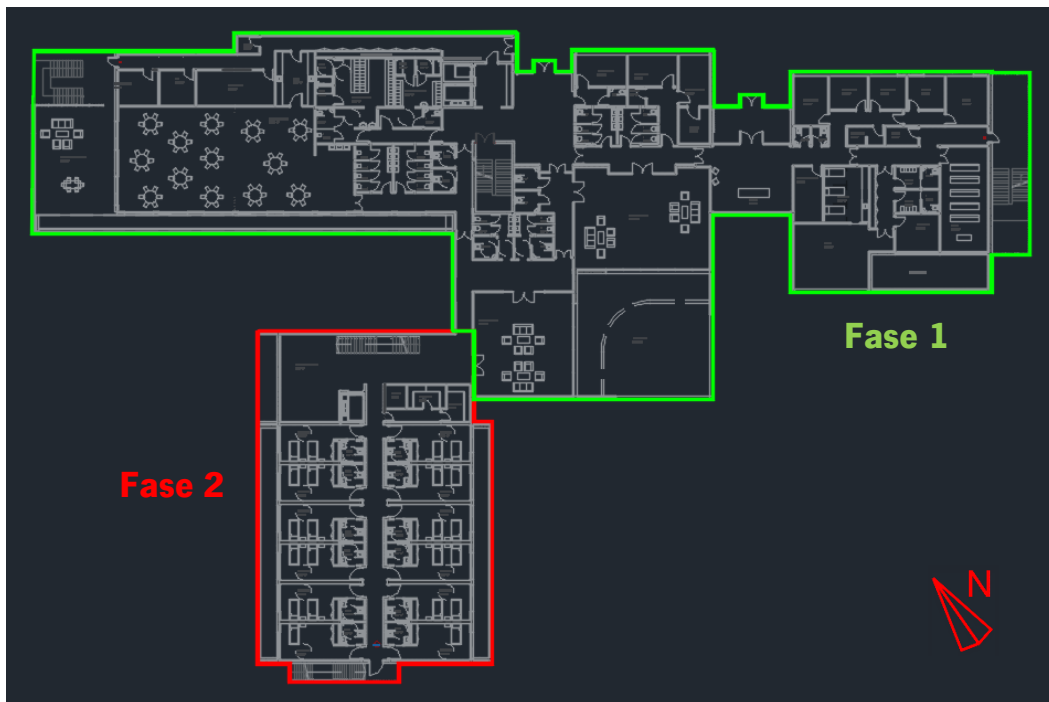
Planta do piso 0 em que se encontram identificadas as duas fases de construção do edifício.
